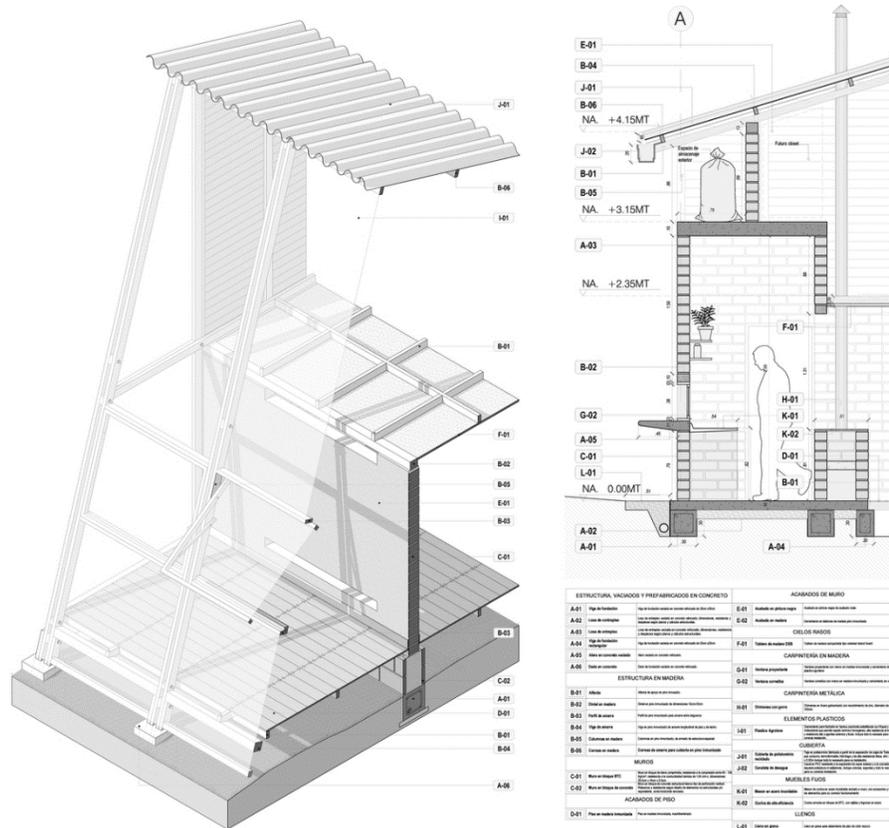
Corte detalle del sistema constructivo, (2009) archidaily
